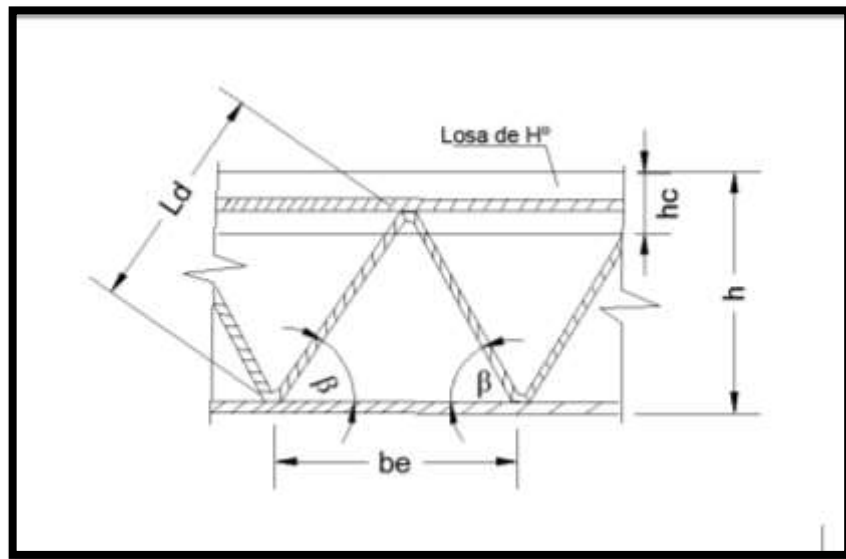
Detalle de una Losa Reticular (Predimensionamiento)
